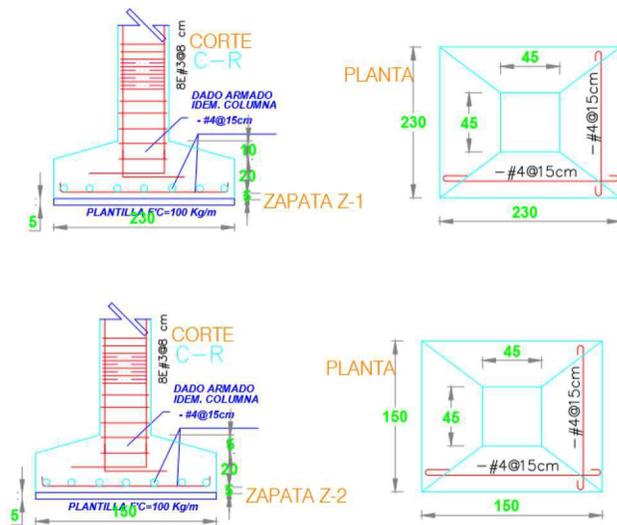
Detalle estructural de la tipología de cimentación en zapatas aisladas.
